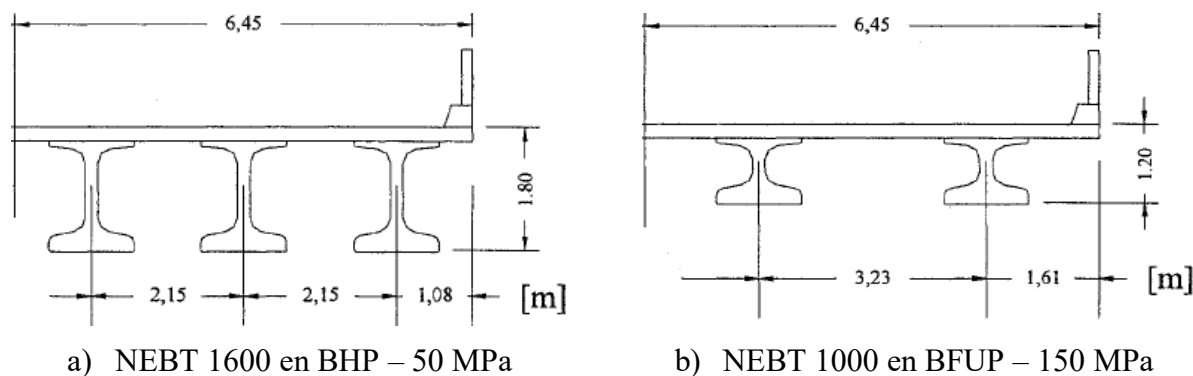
Comparaison d'un pont avec des poutres NEBT en BHP et BFUP (Braike, 2007)
